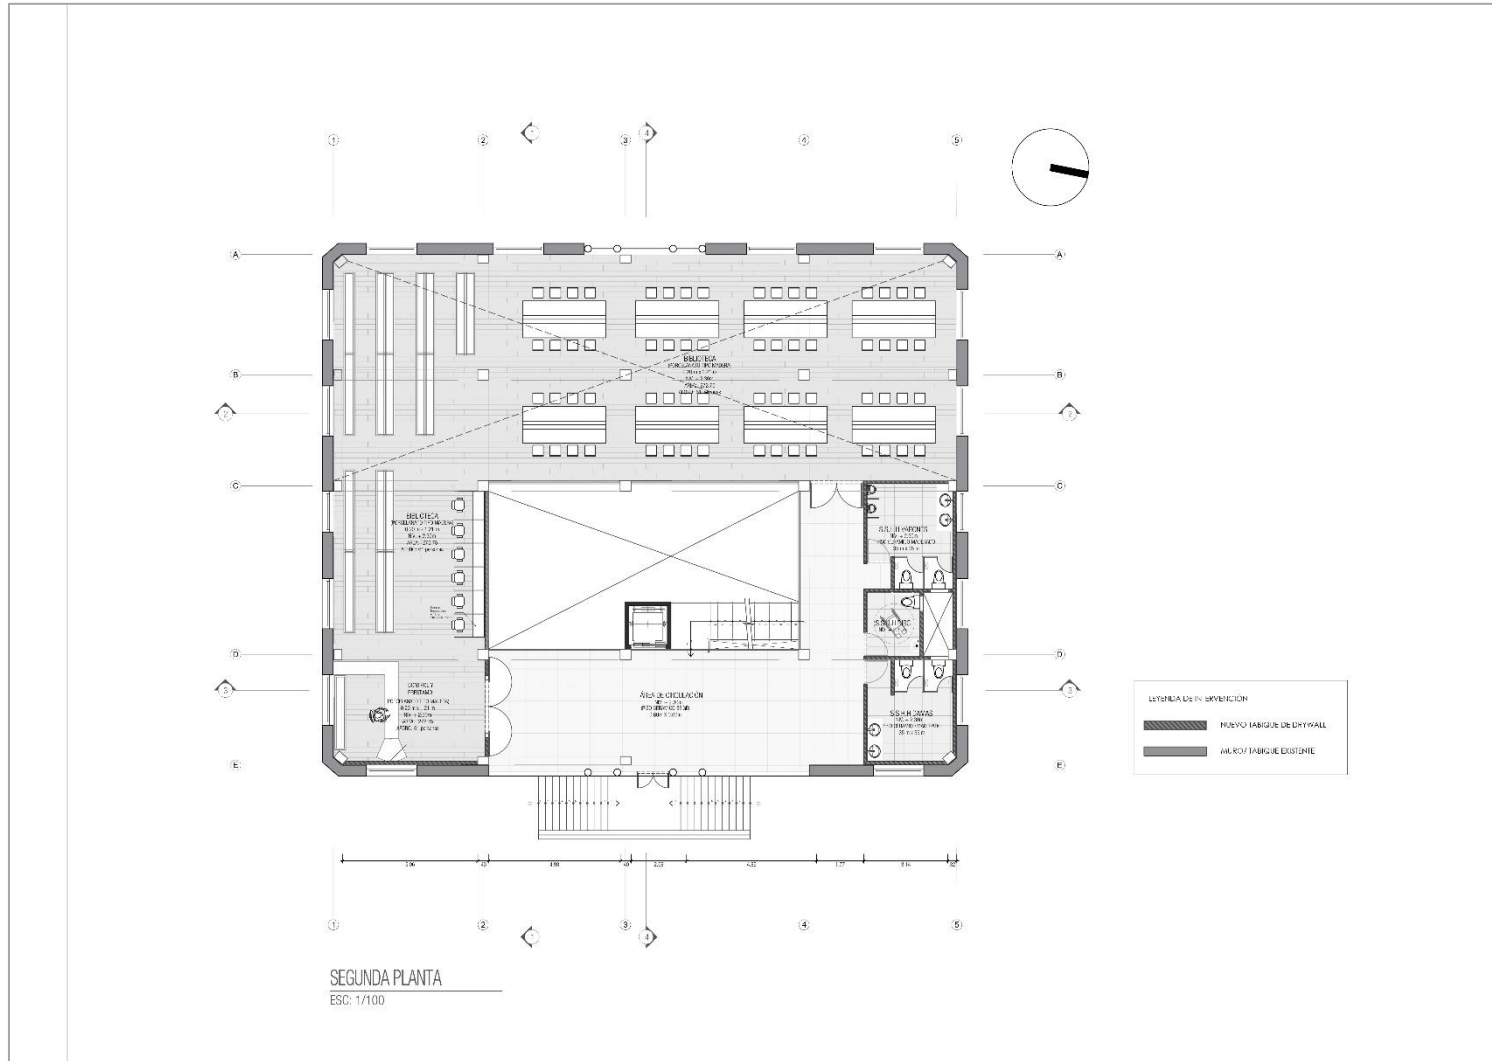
Segunda planta - mezzanine arquitectura, escala 1:100
